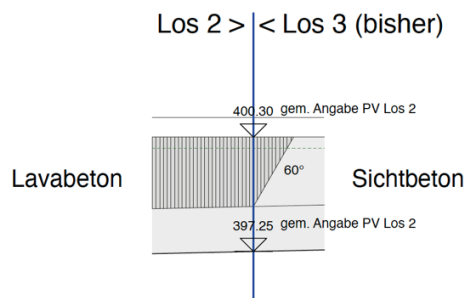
a) Schema Übergang Lavabeton-Sichtbeton (exemplarisch) bei Stützmauern Helgefild
